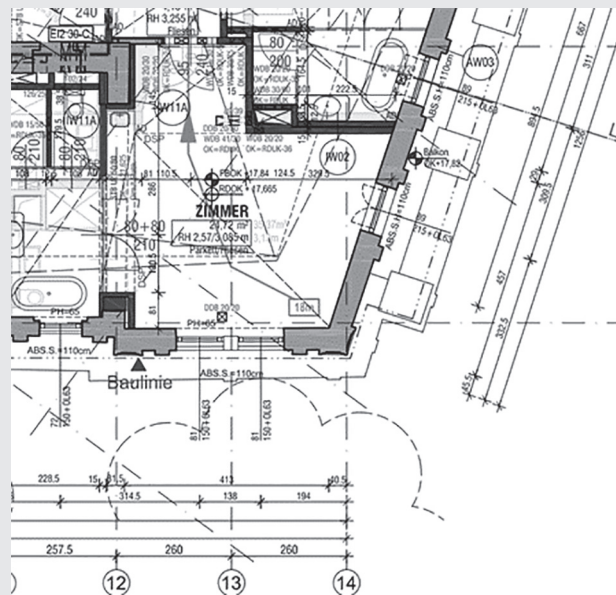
Auszug aus einem Einreichplan (Grundriss – Kettenbemaßung inkl Höhenangabe)
